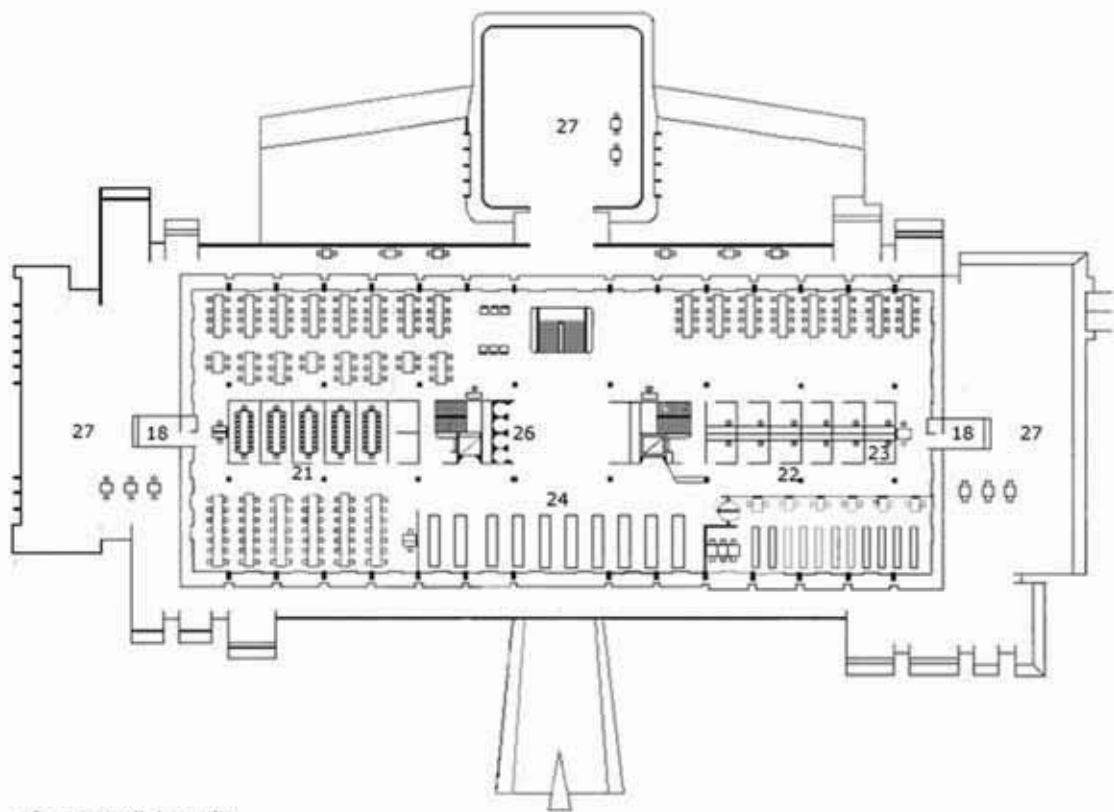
Biblioteca Nacional de Salvador - Pavimento Térreo
